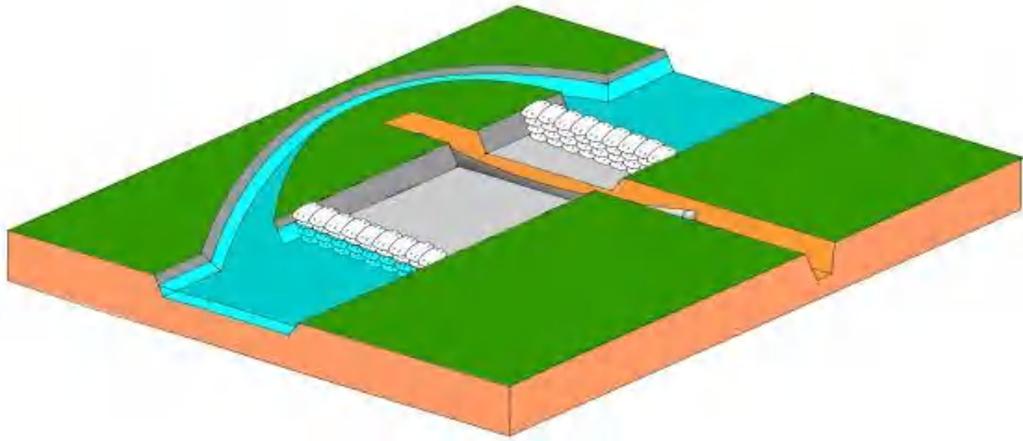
围堰导流开挖管沟法施工断面示意图
